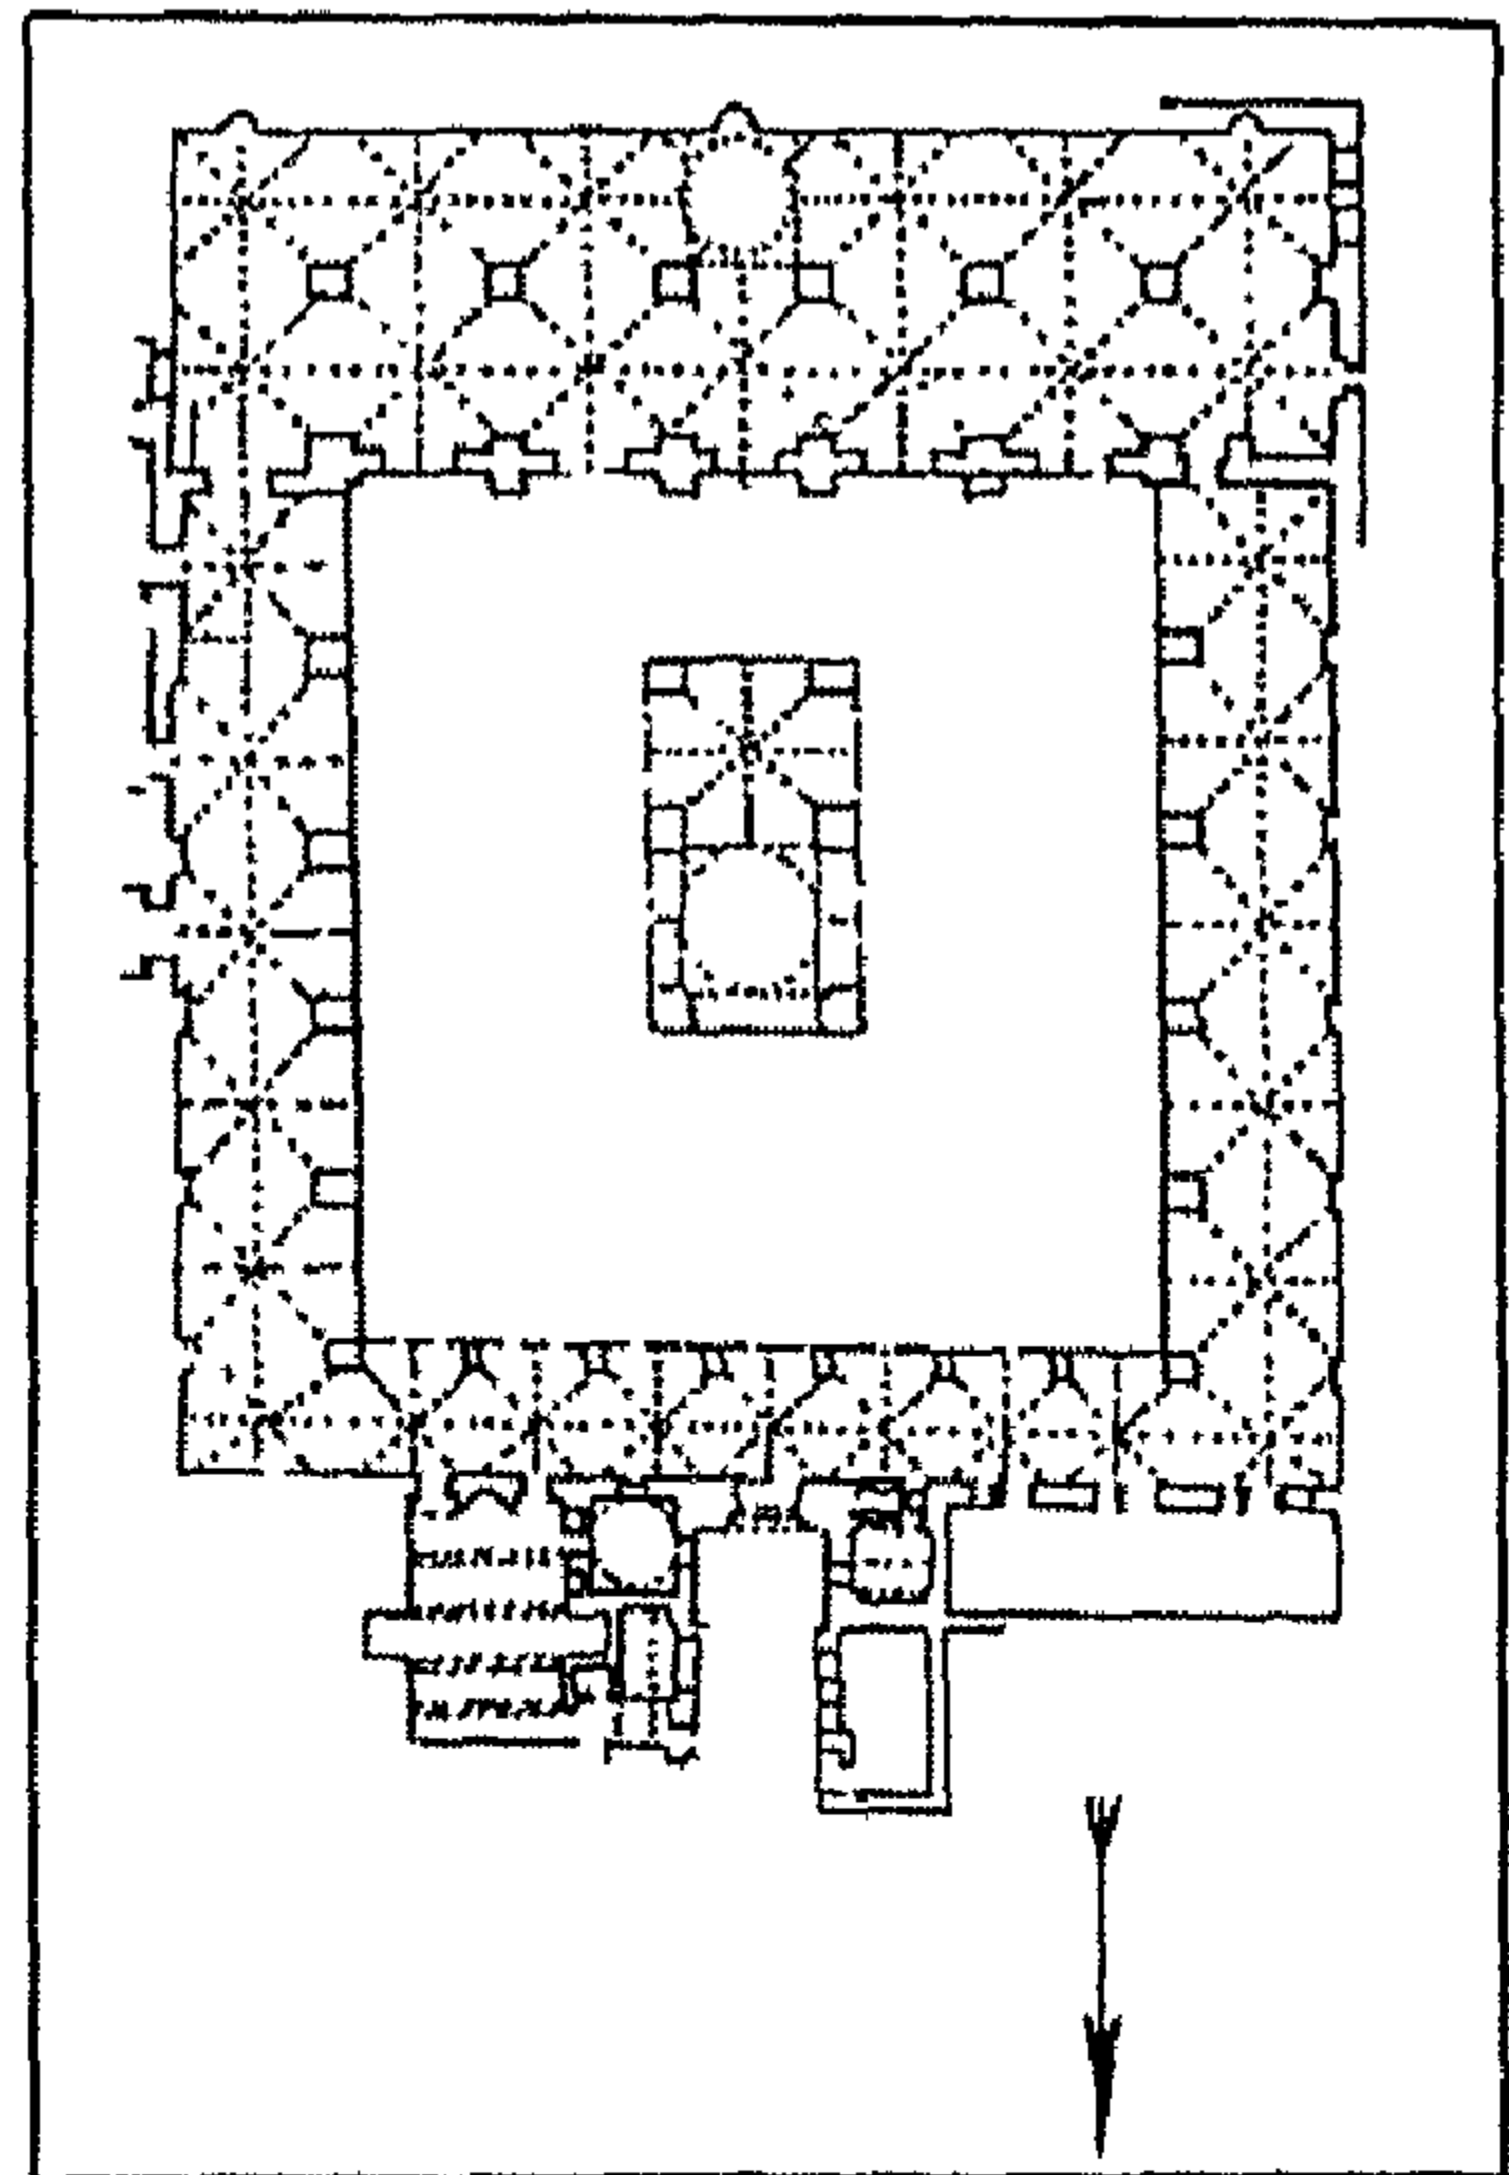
مجموعة السلطان قلاوون (مسقط أفقي)
